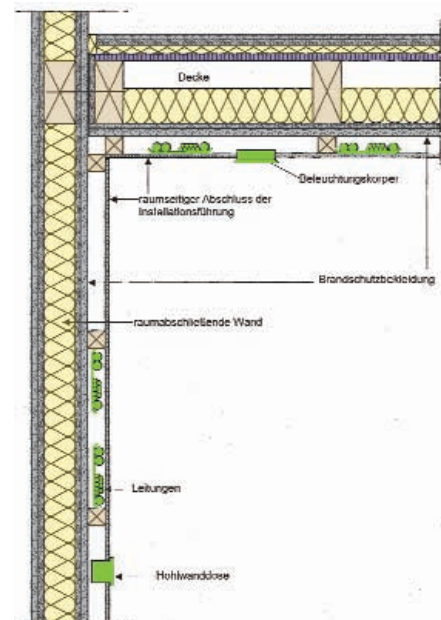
Installationsführung in einer Vorwandschale bzw. abgehängten Decke nach [25]
